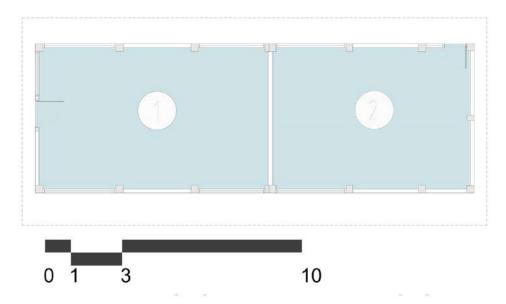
Planta 1 Bloque 55. Fuente: Equipo de diagnóstico.
